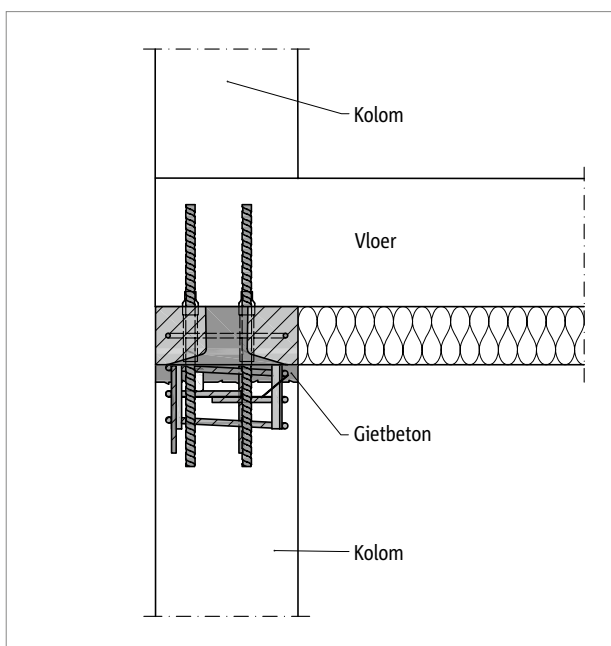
Schöck Sconnex® type P: Aansluiting kolom op bovenliggende vloerplaat
